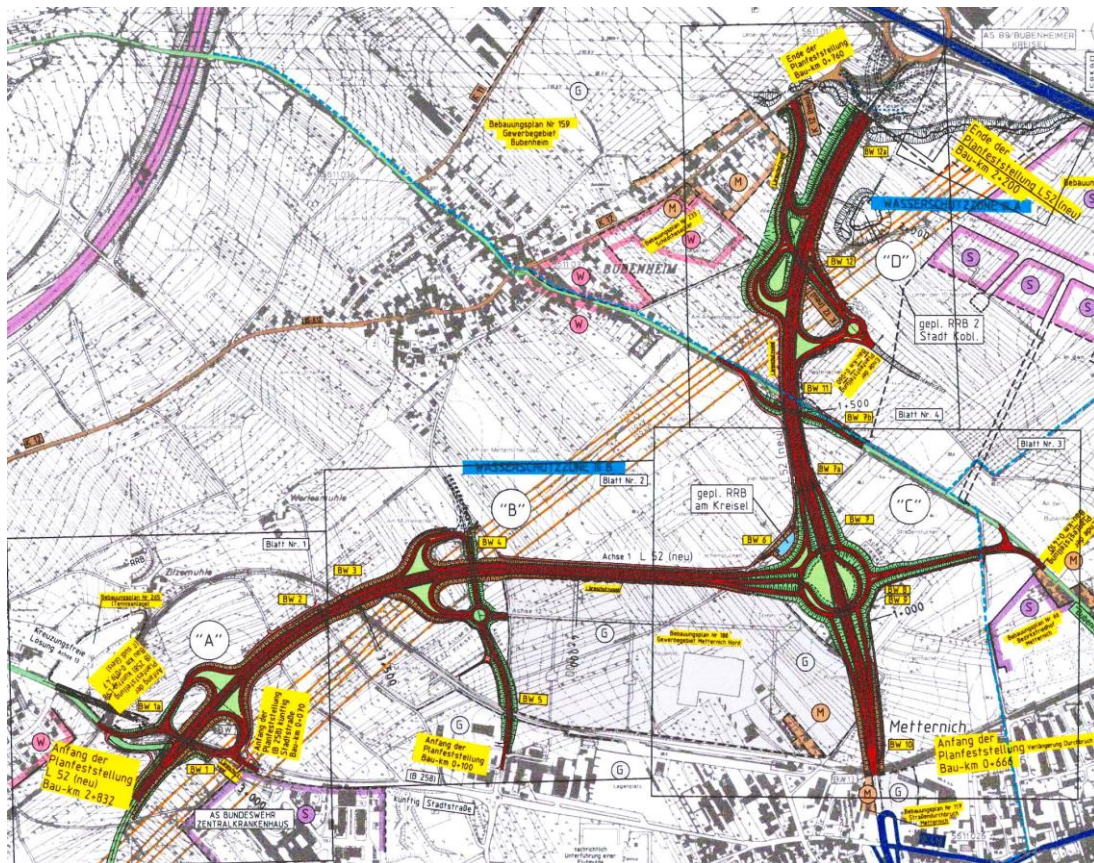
Übersichtsplan zur Planfeststellung Nordtangente 2004
